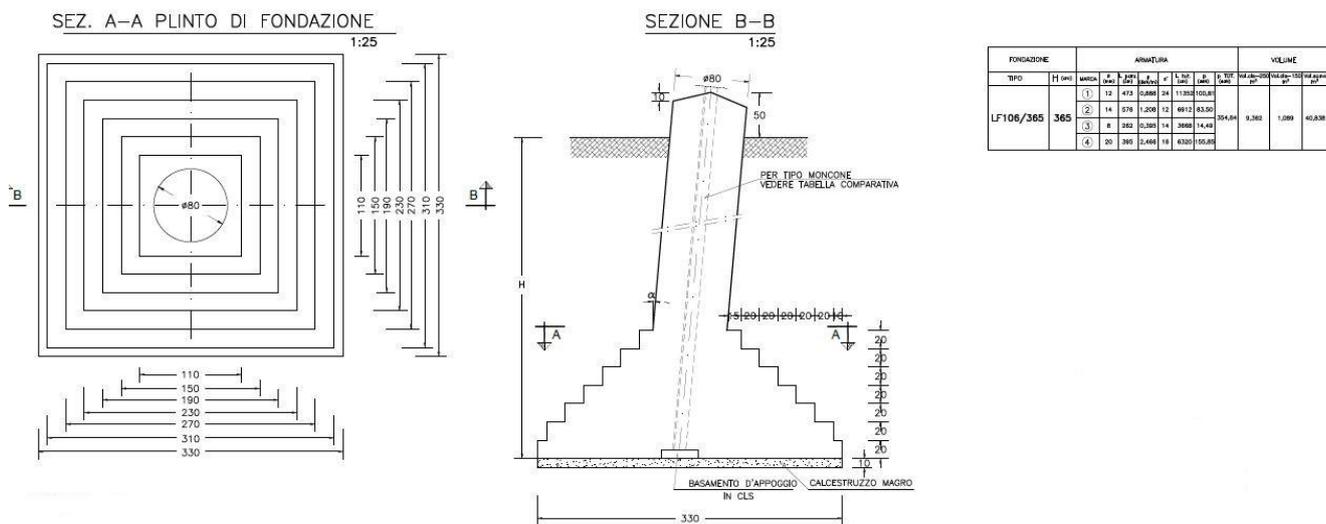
Fondazione a plinto con riseghe tipo per palo di amarro singola terna
